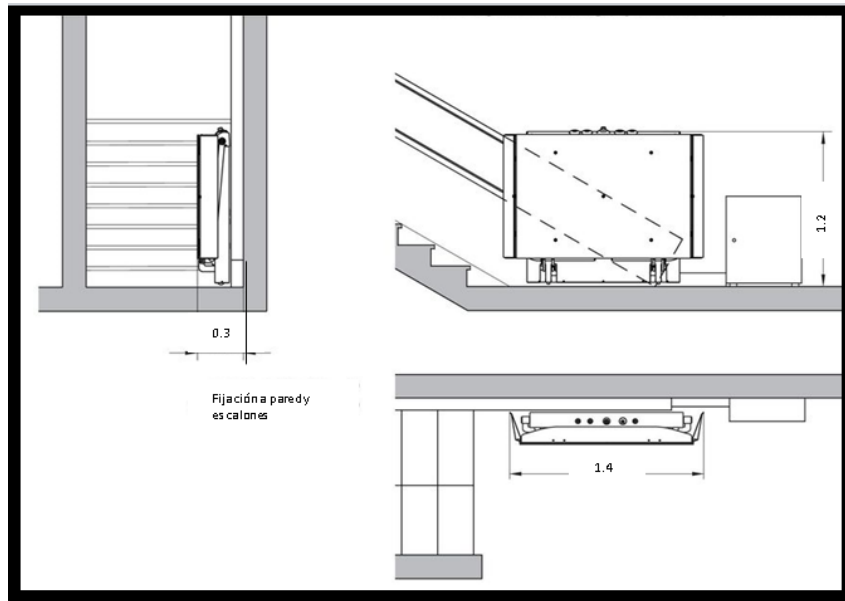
Propuesta arquitectónica en zona 3 para adaptación de salvaescalera (Fuente: elaboración propia, 2018)
